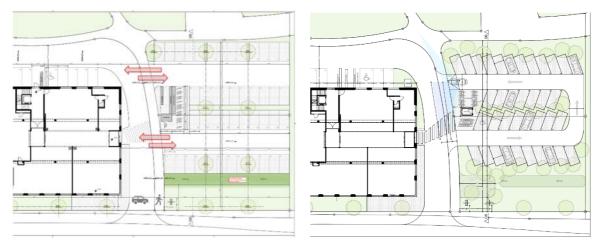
Entwurf Umgebungsplan Projekt (links); neuer Umgebungsplan Projekt Essane Center (rechts, Stand: 10.02.2023)
